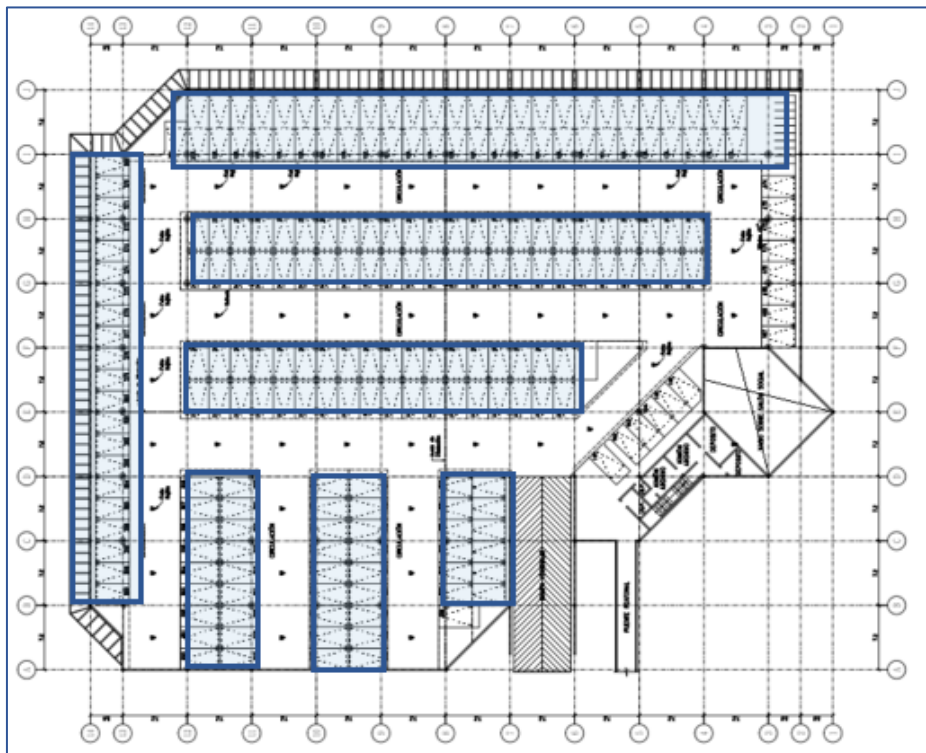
Planta de cubiertas. Área cubierta en segundo nivel. Fuente: elaboración propia.
